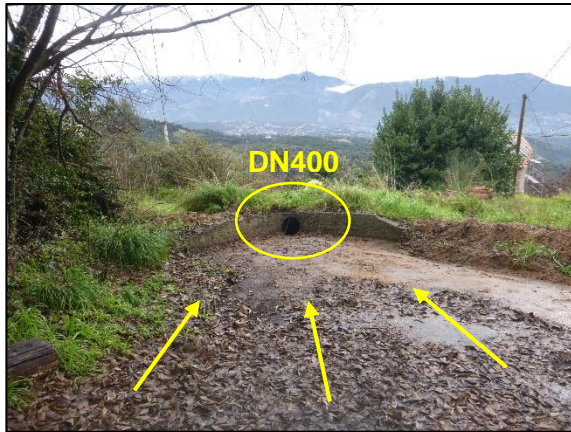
BV n°9, conduite et départ vers la RD 161 (sortie n°1)
